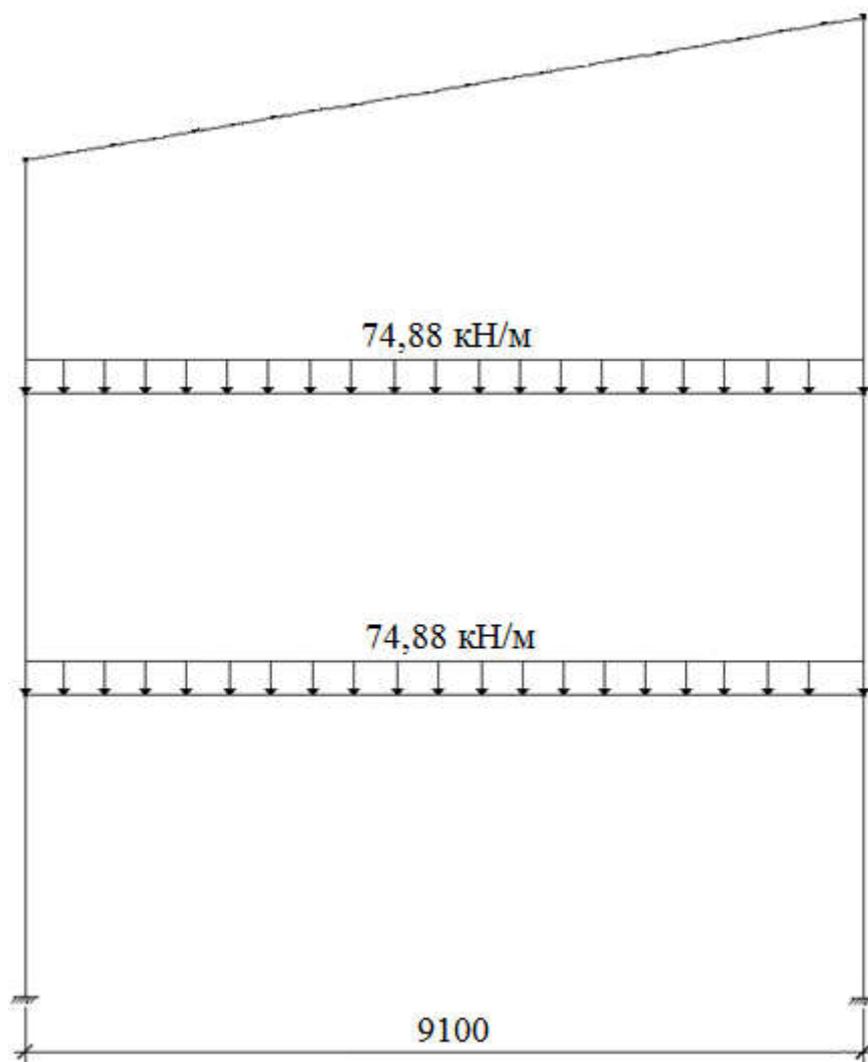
Кратковременная нагрузка на перекрытия
